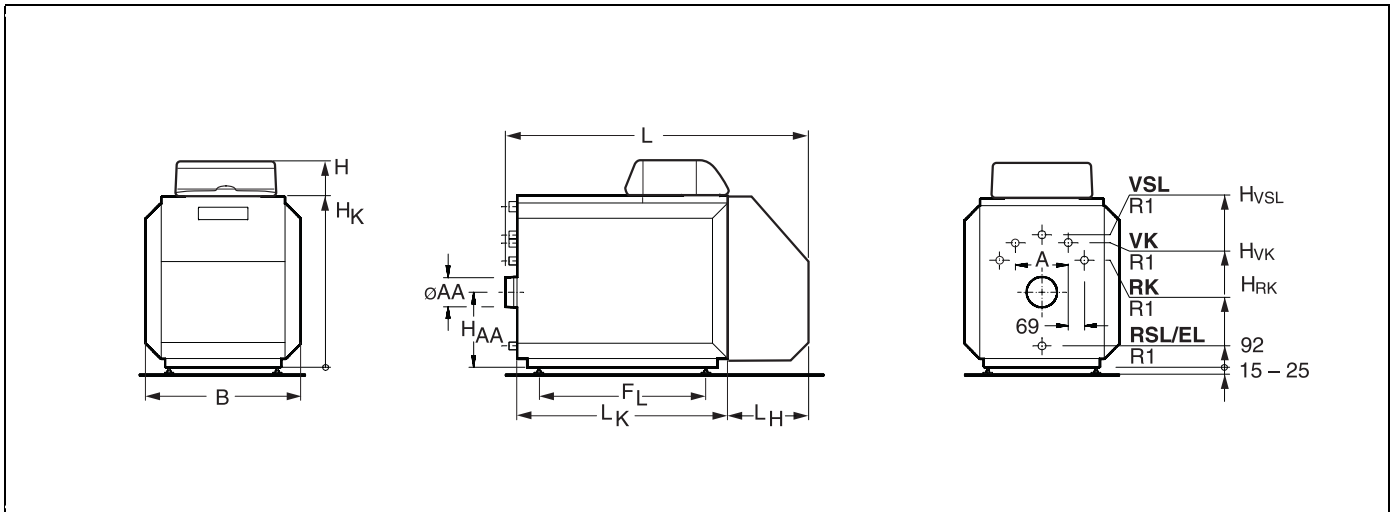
Anschlüsse und Abmessungen (Maße in mm)
